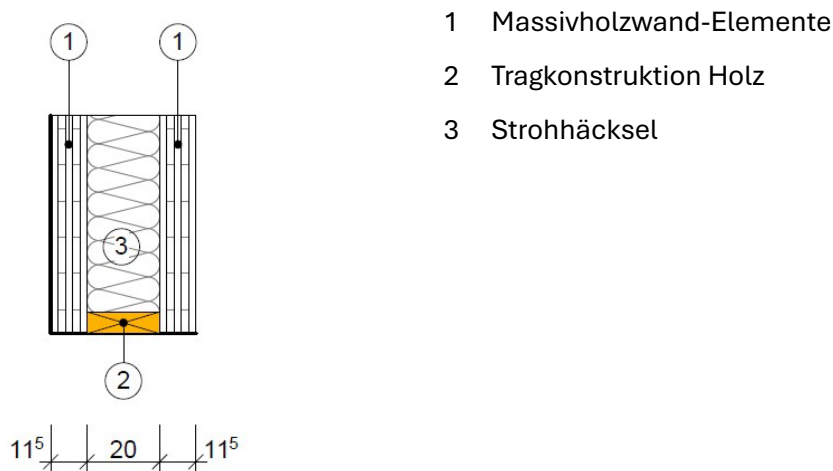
Skizze Wandaufbau (aus Machbarkeitsstudie BauWerk Erfurt, Unterauftrag Startervorhaben 3, 2023)
